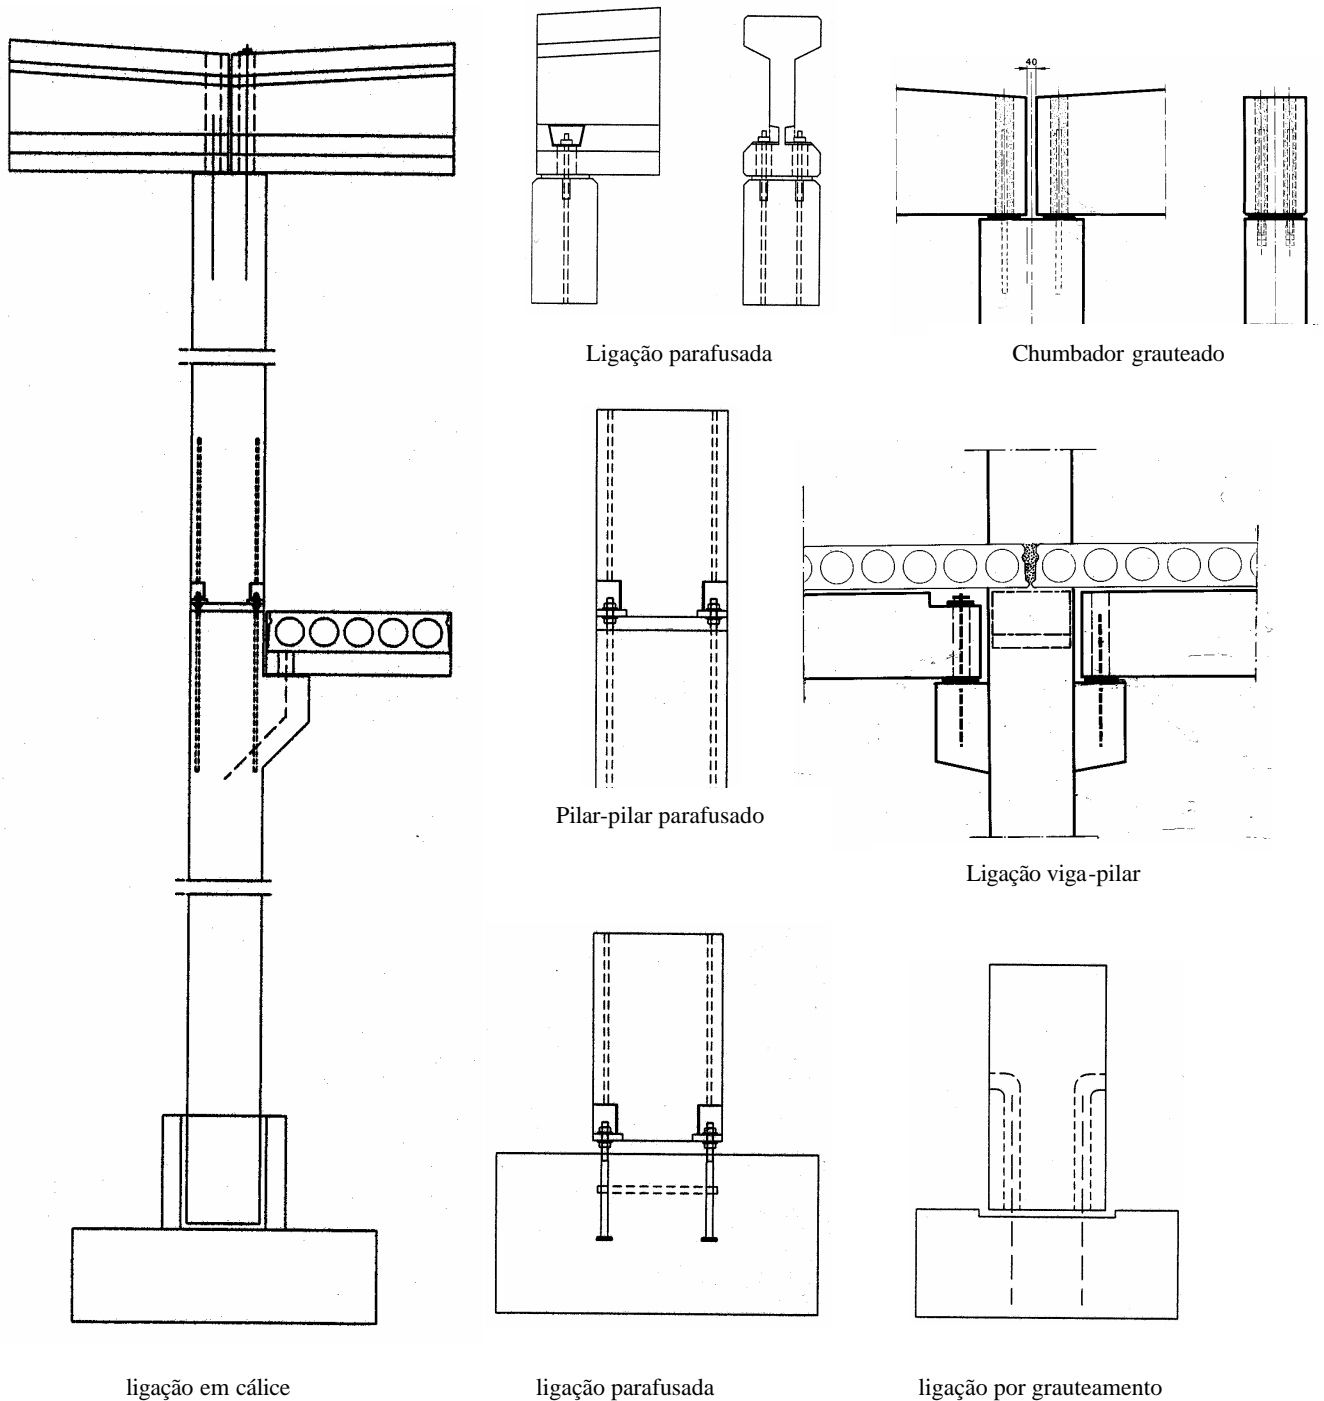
exemplos de típicas ligações em pórtico e estruturas de esqueleto
